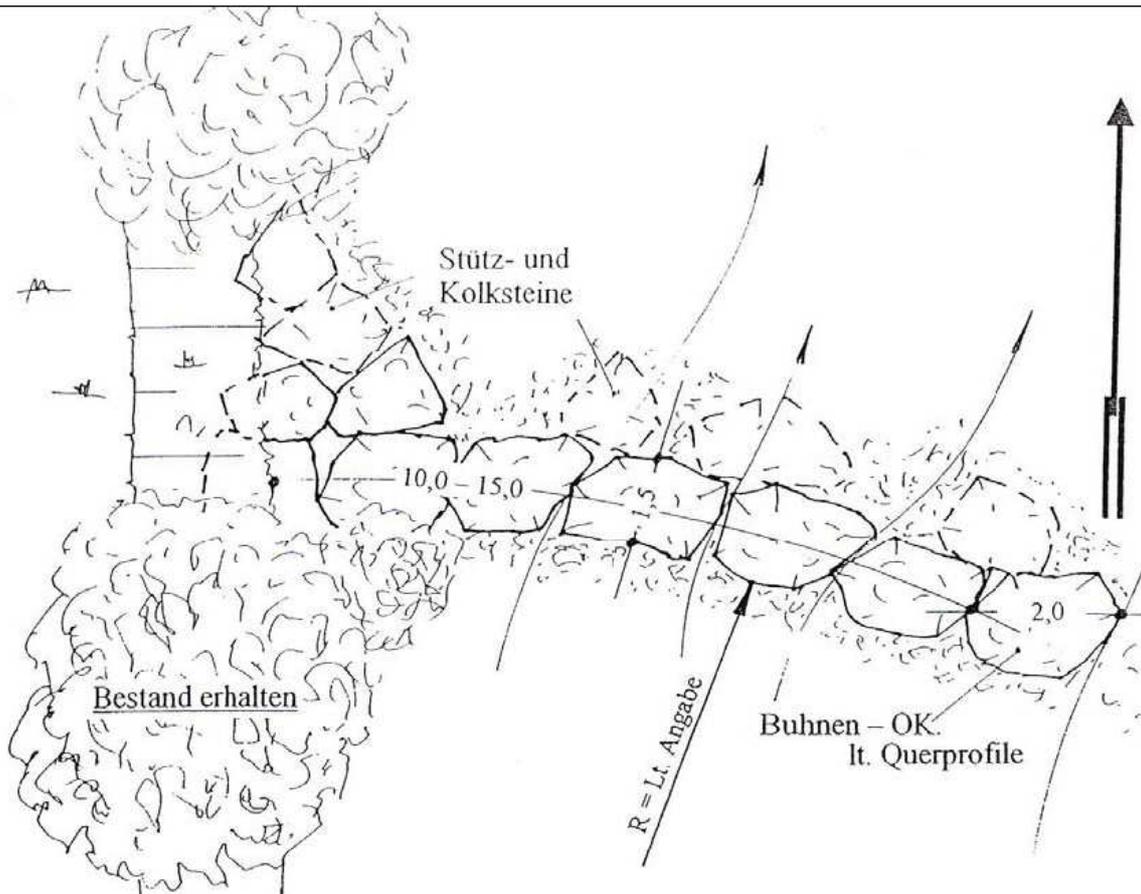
Lageplan einer Sohlgrundbühne mit Strömungsfäden (von Otmar Grober)
